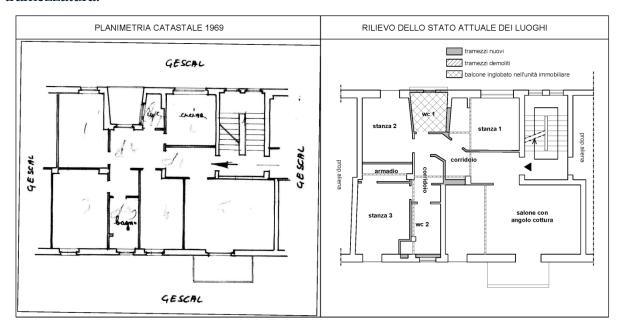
Confronto tra la planimetria catastale e il rilievo dello stato dei luoghi con individuazione delle difformità
